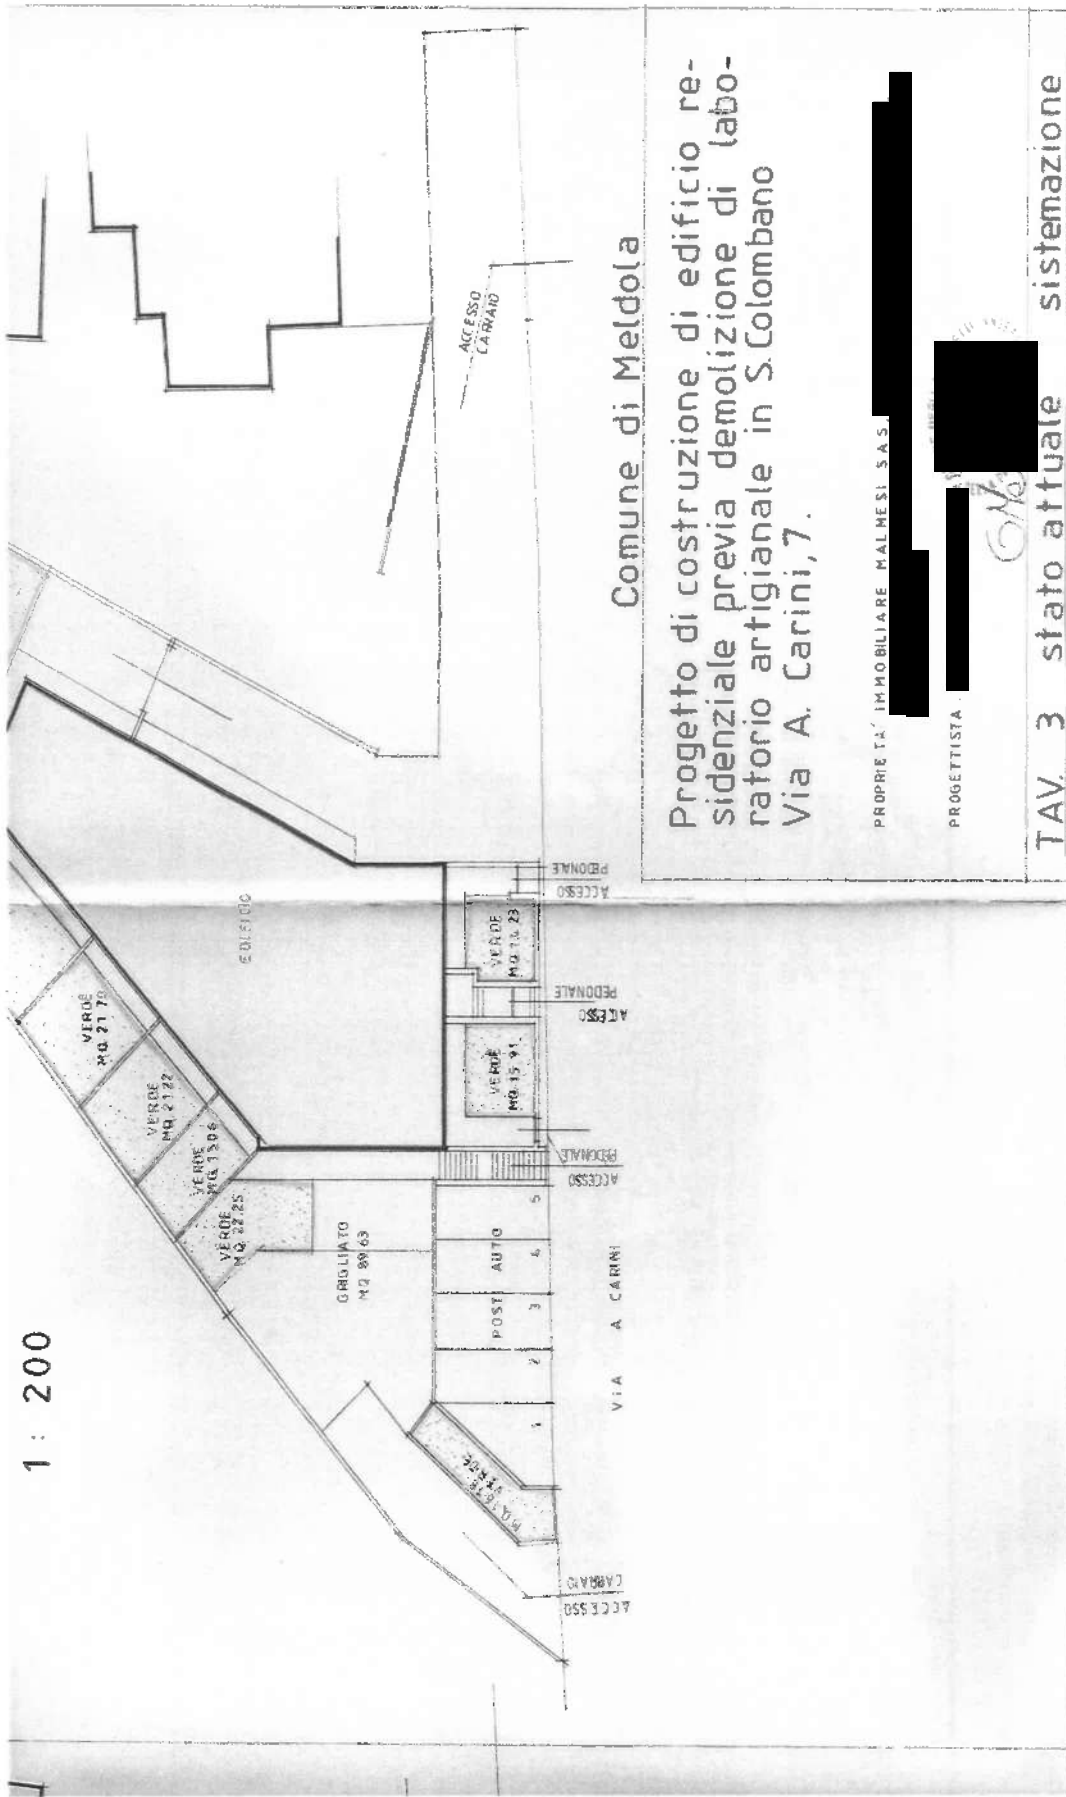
Pianta 4 – Sistemazione area e Frontespizio (Si notino le proprietà coinvolte)
